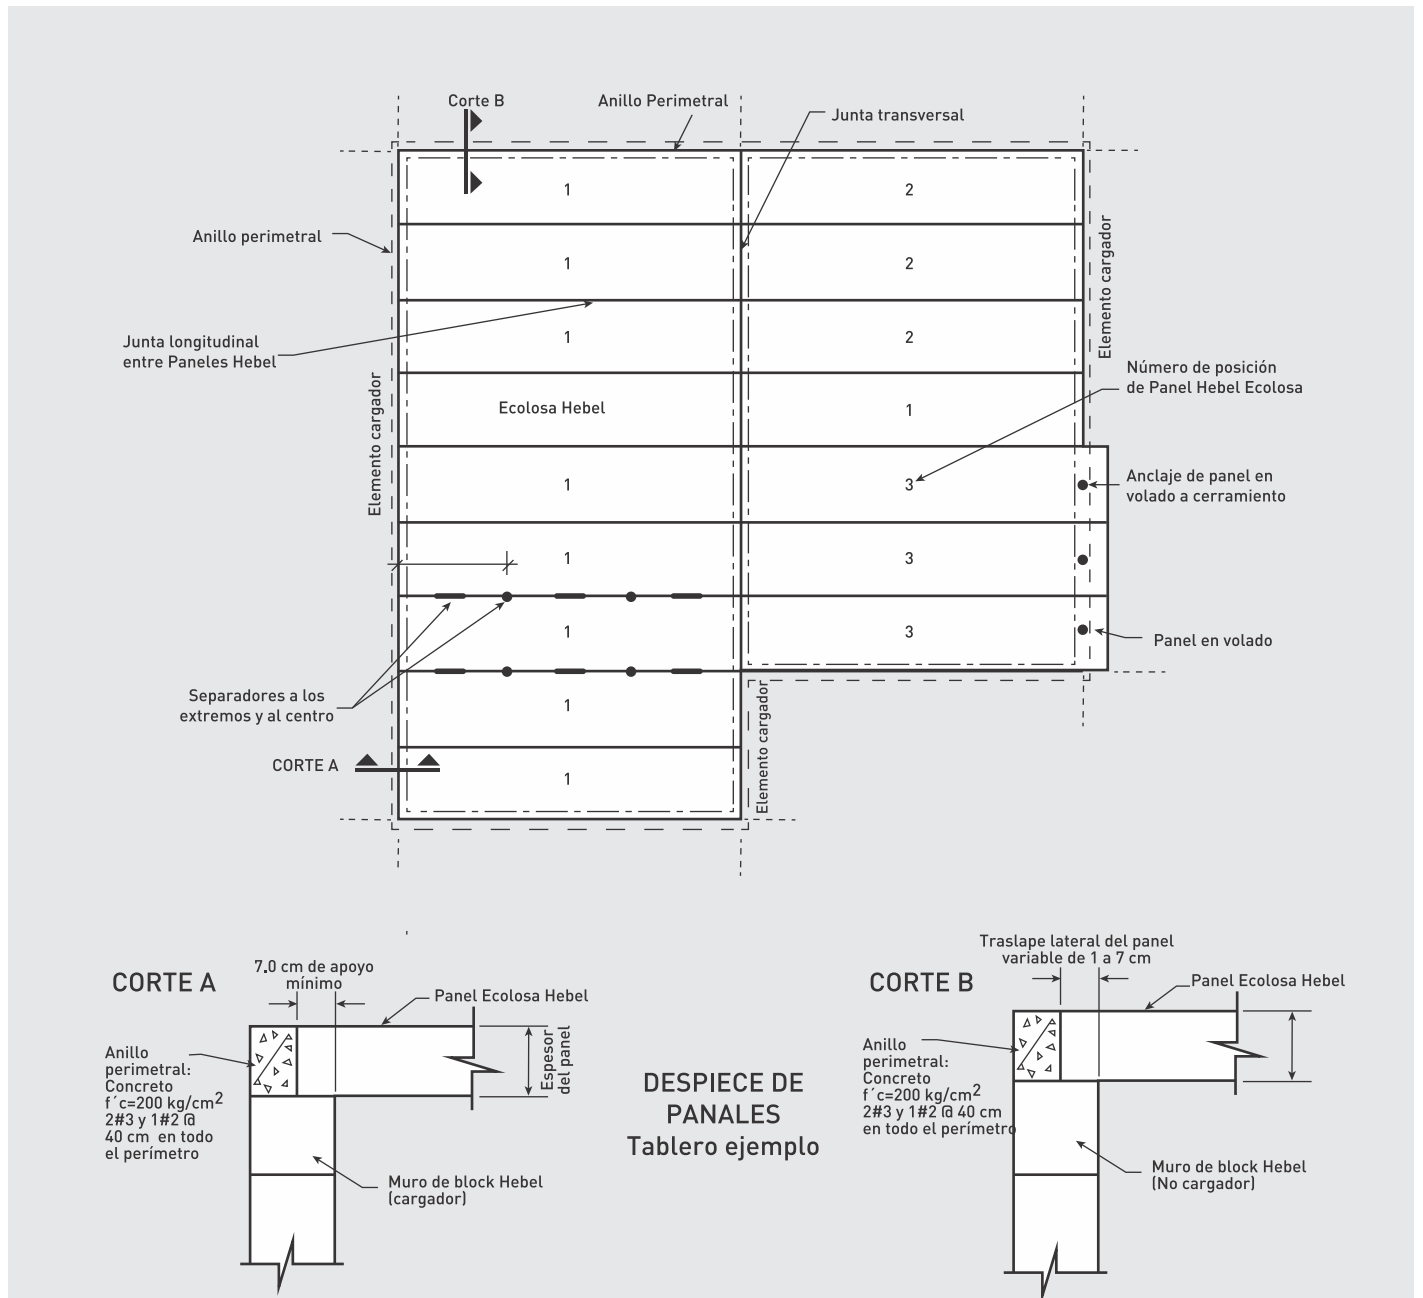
Tablero tipo de apoyo de paneles sobre mampostería.
